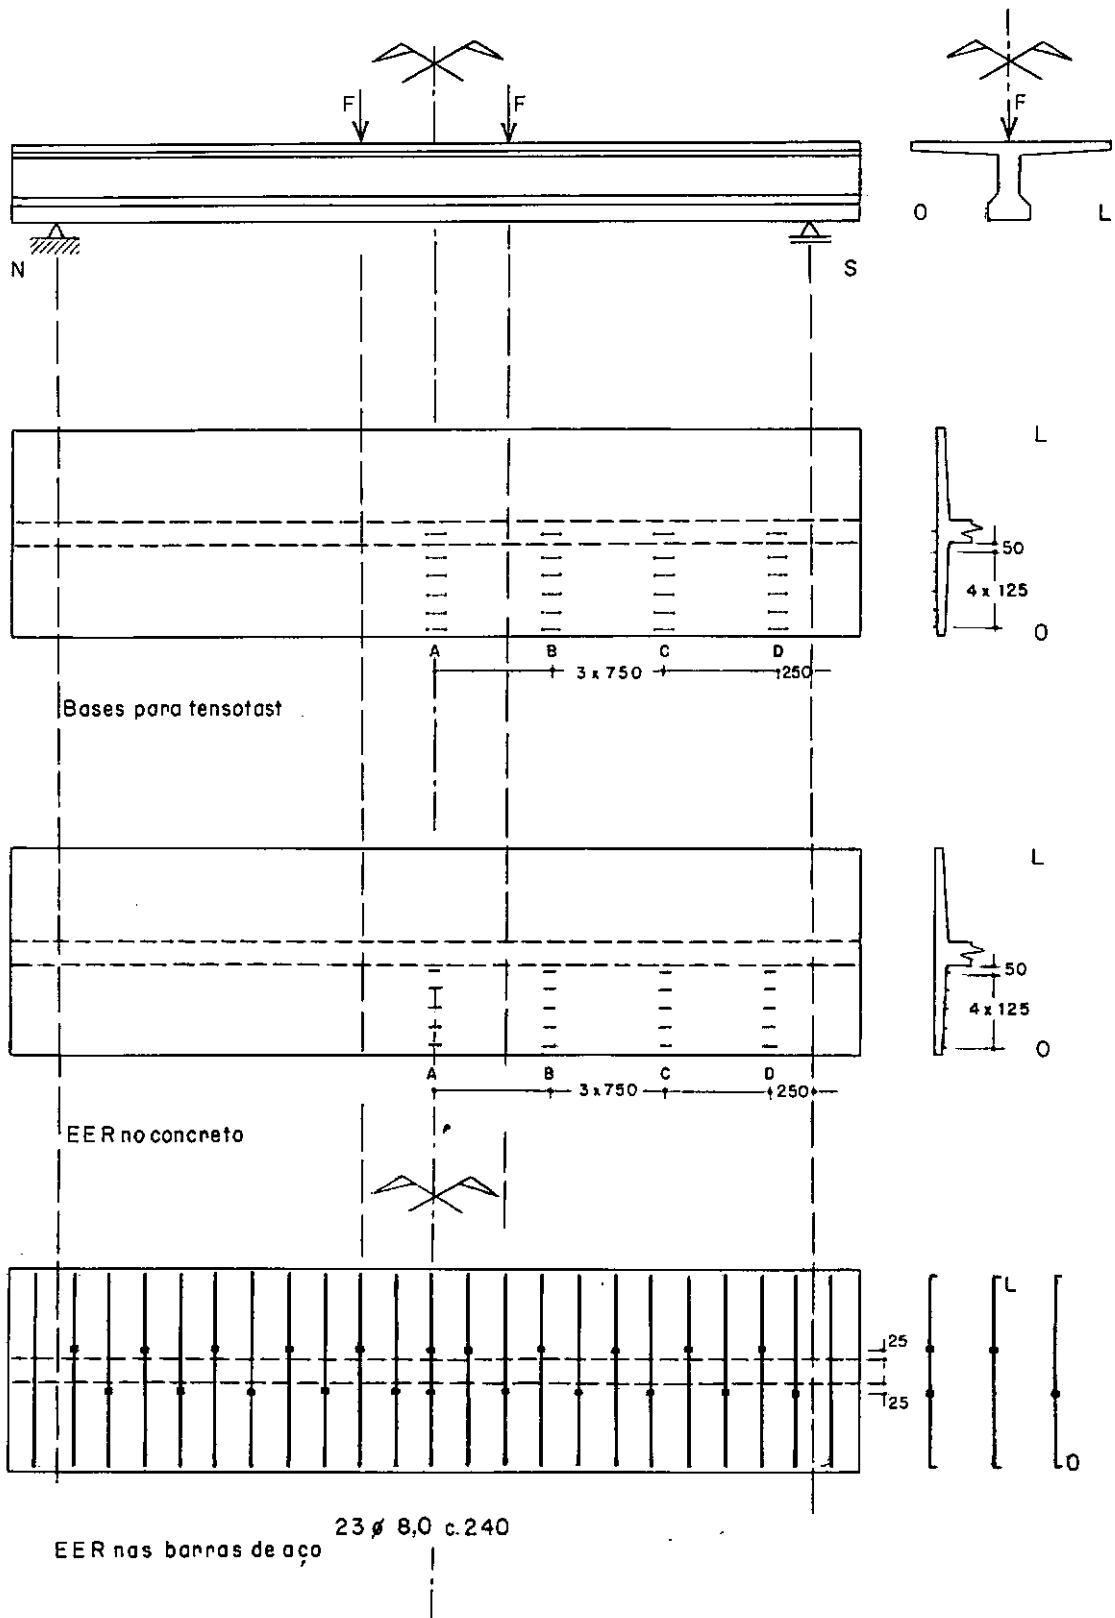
e - Instrumentação da viga T5 - (cotas em mm)
